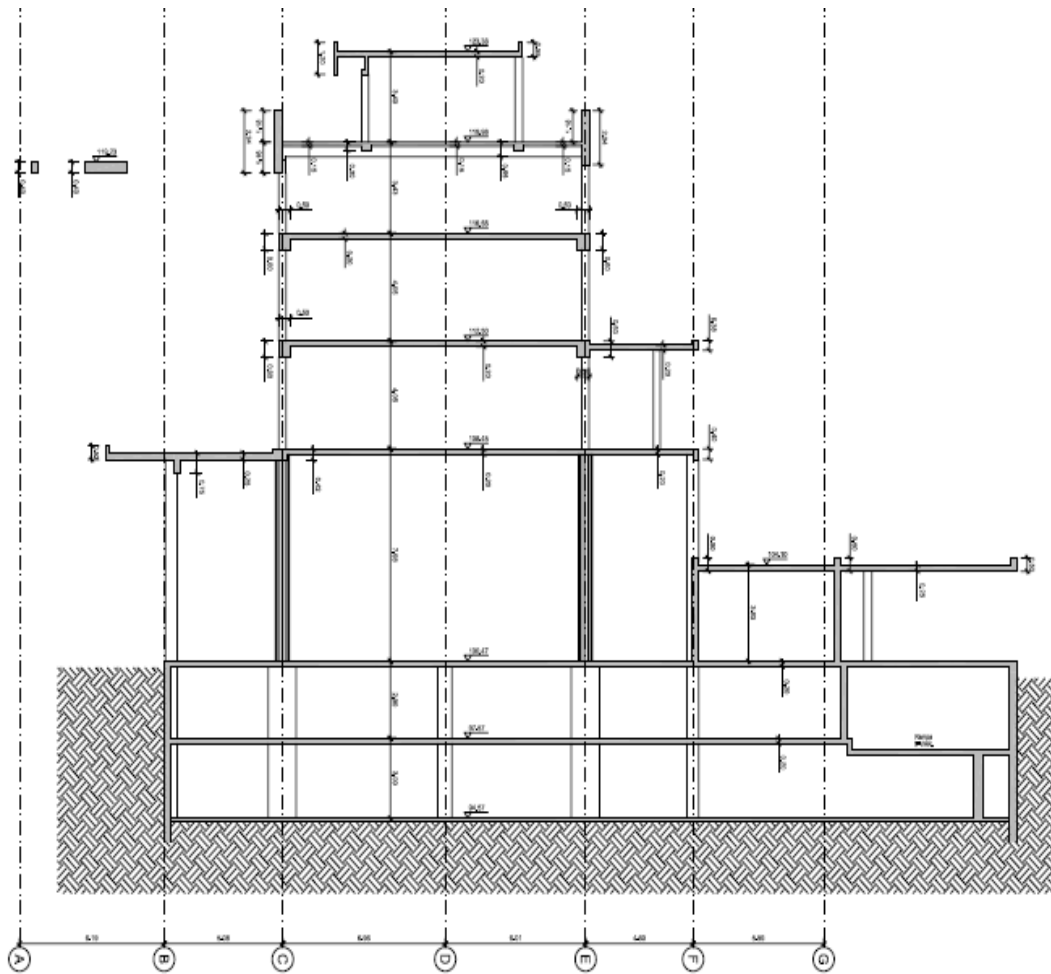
CORTE TIPO II DA ESTRUTURA - TRANSVERSAL (AUTOCAD)
